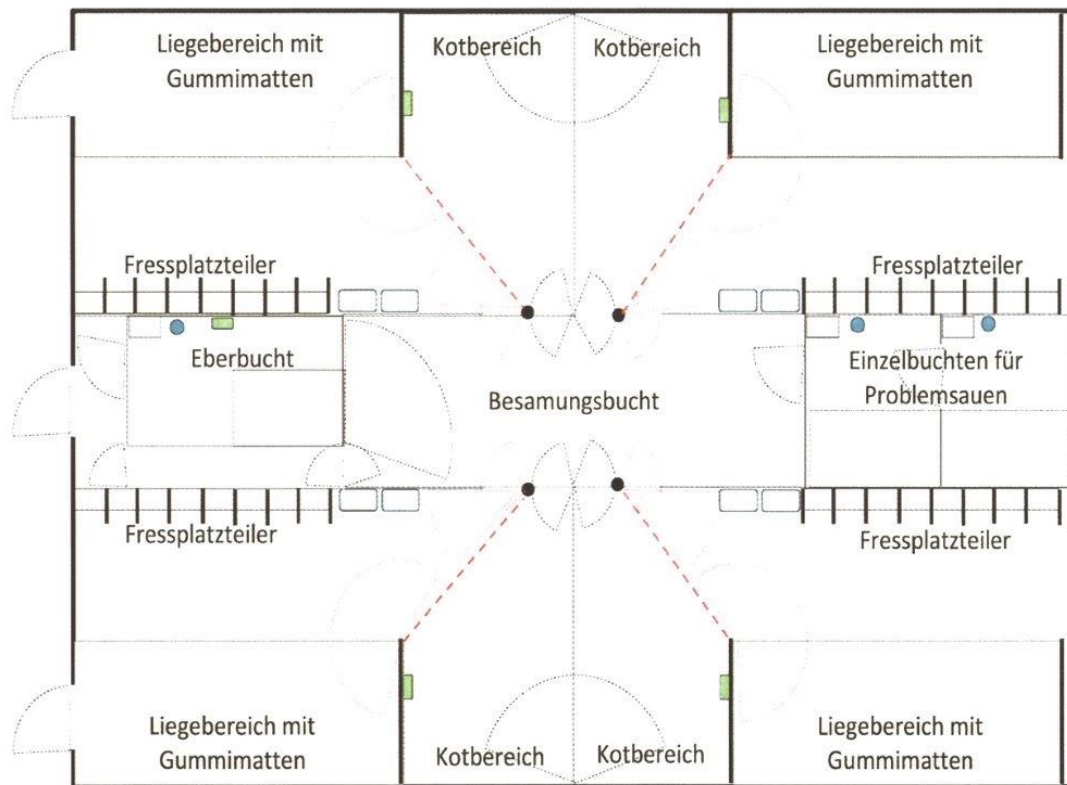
Möglicher Grundriss eines Deckstalles für das Gruppenbesamen [4].
